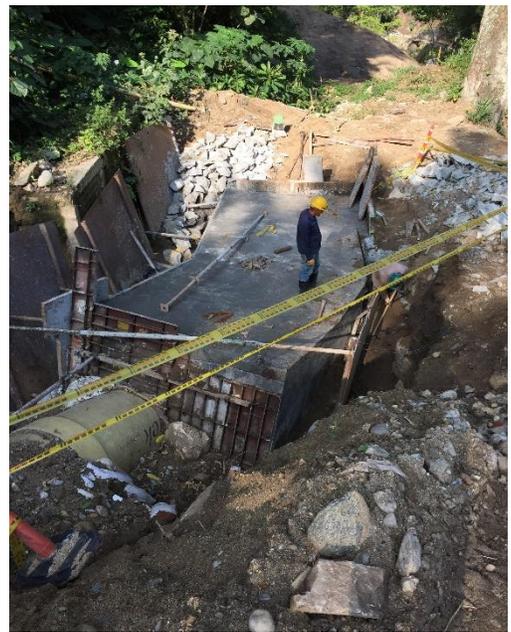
Proceso construcción anclaje a tubería GRP. Fuente: Propia
